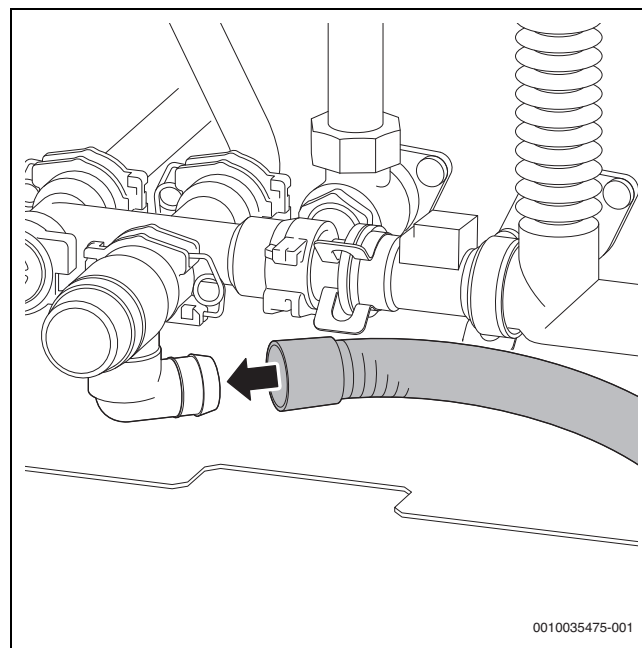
Montage du tube sur la soupape de sécurité (circuit ECS)
